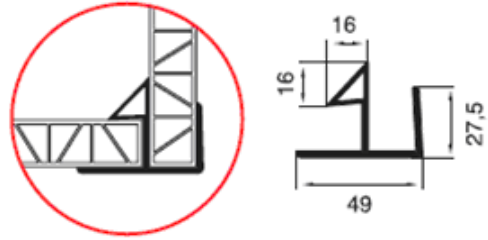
Pladeck döşeme 625mm*2500mm*21mm
